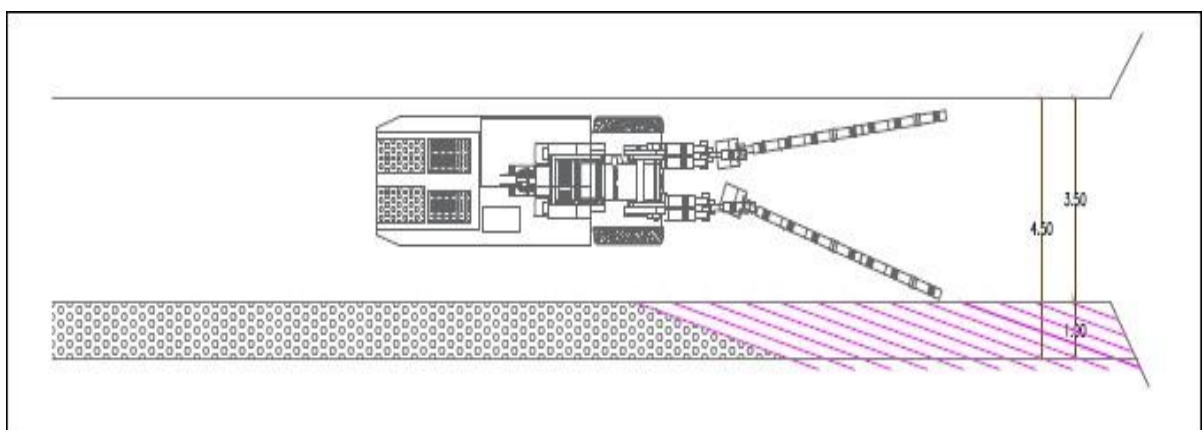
Diseño de perforación para desquinche en vista planta de sección 4.5x4.5m
